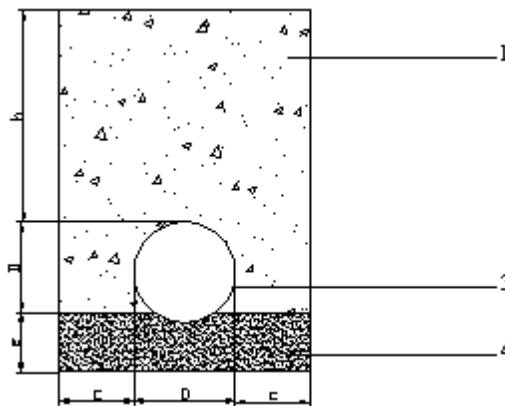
coupe transversale d'une tranchée avec la mise en place de la conduite
